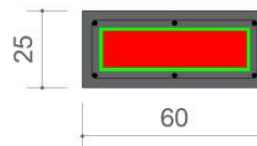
Ilustração de um pilar, demonstrando como deve ser realizado a escarificação dos pilares deteriorados.
